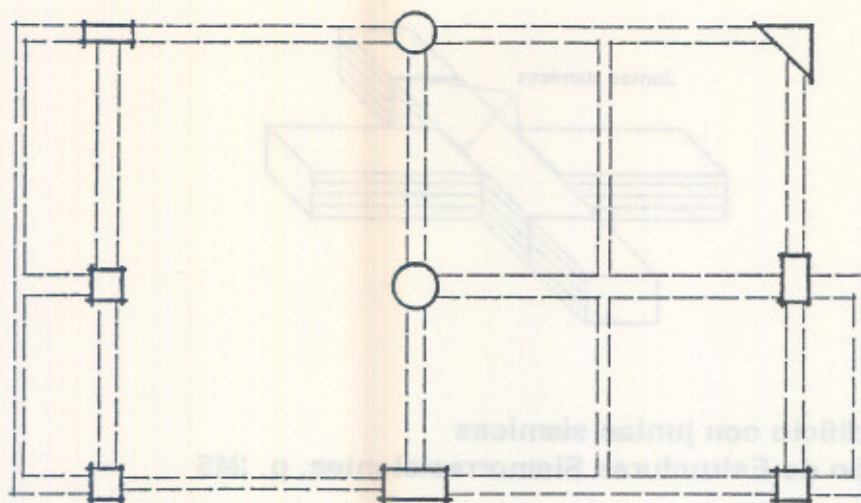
Planta de distribución asimétrica de columnas y vigas
